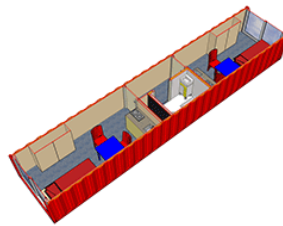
Proyecto Keetwonen, Amsterdam-Holanda
